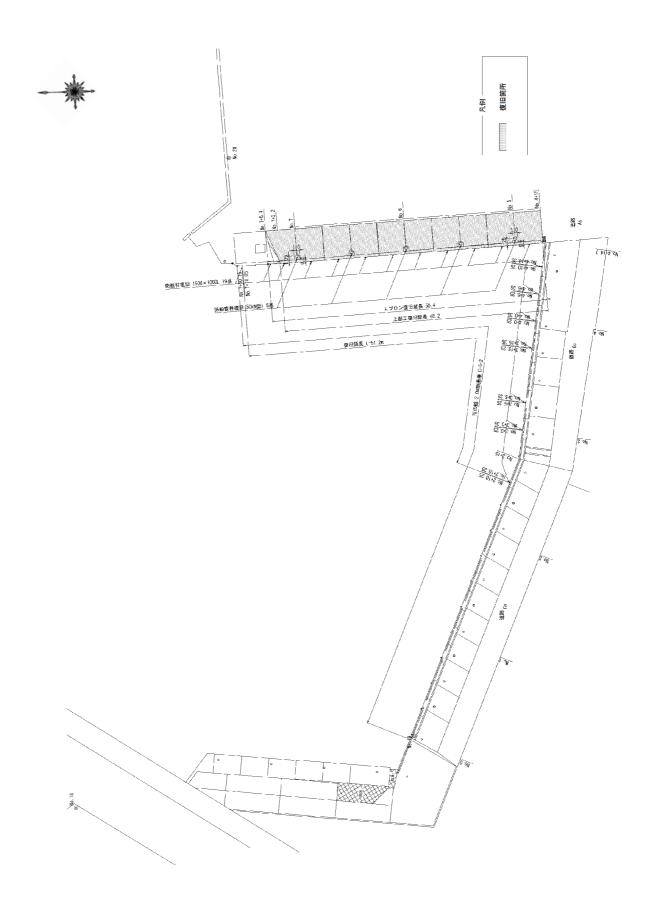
No.9 玉の脇-2.0m物揚場の平面図(復旧後)
